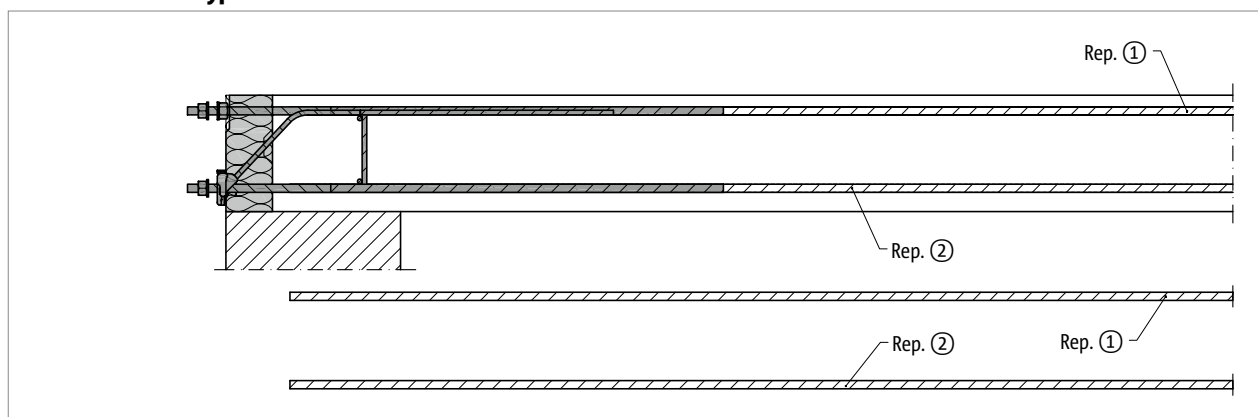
Schöck Isokorb® T type SK-MM1-VV1 : armatures à prévoir par le client, vue en coupe
